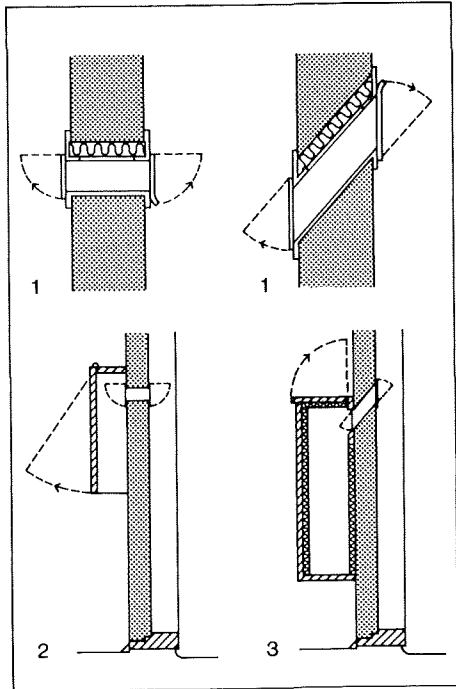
Lydsluse med to døre mellem bolig og fælles adgangsrum. Plan 1:50.
